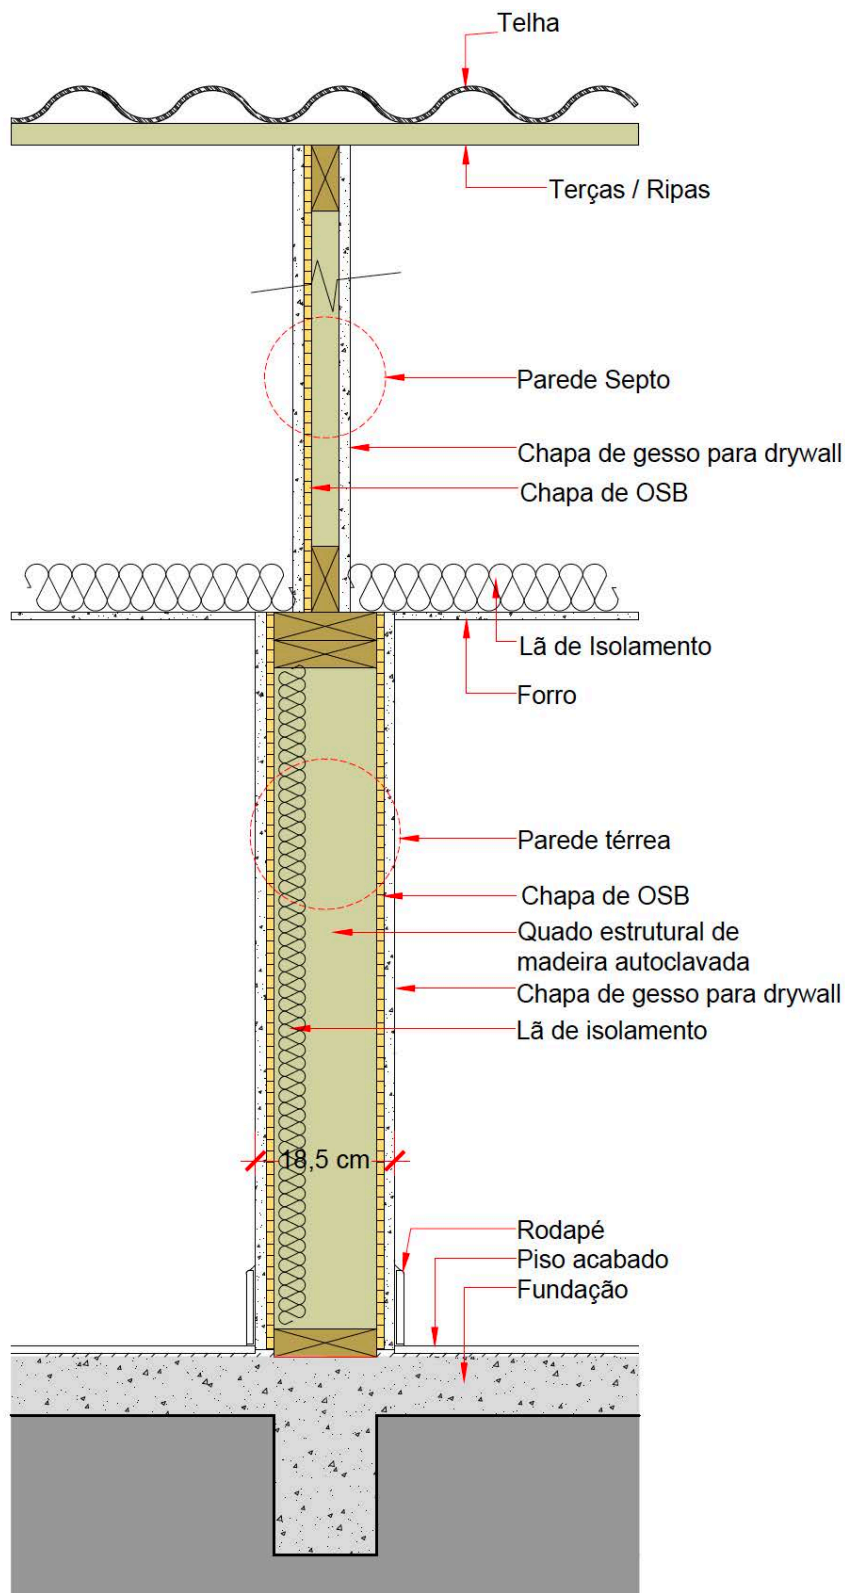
Detalhe em corte da interface entre parede de geminação simples e sistema de cobertura.
